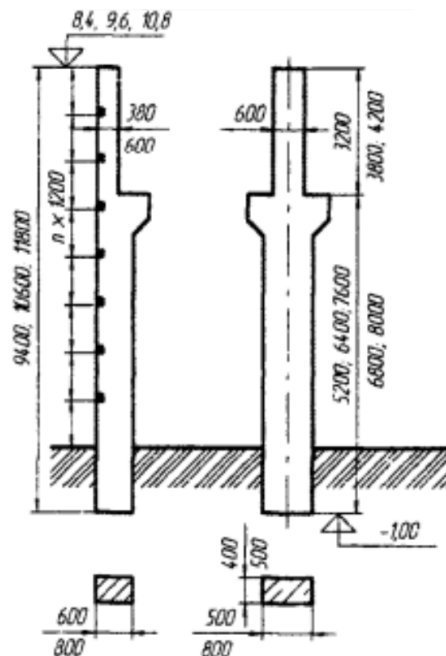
Залізобетонні колони одноповерхових кранових промислових будівель
